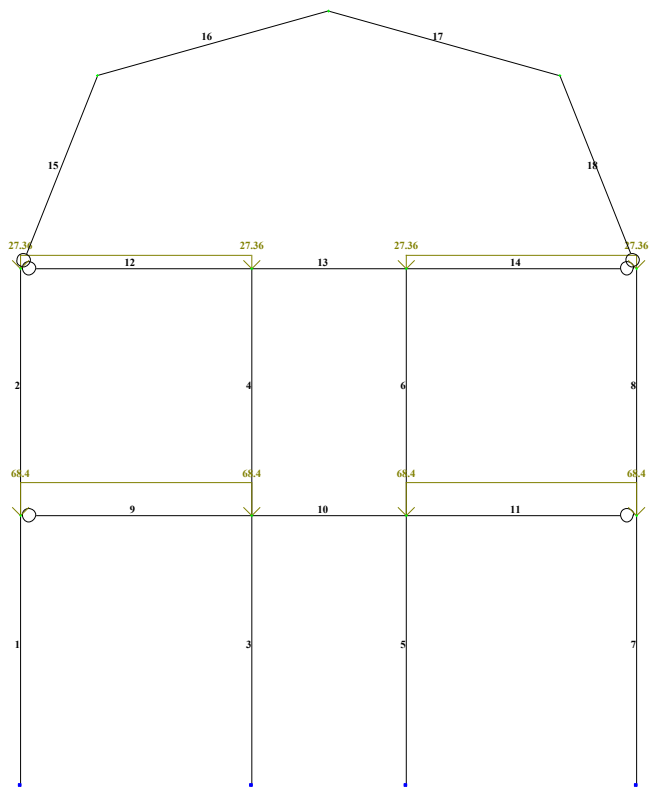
Расчетная схема от временной нагрузки на междуэтажные перекрытия(2 вариант).
